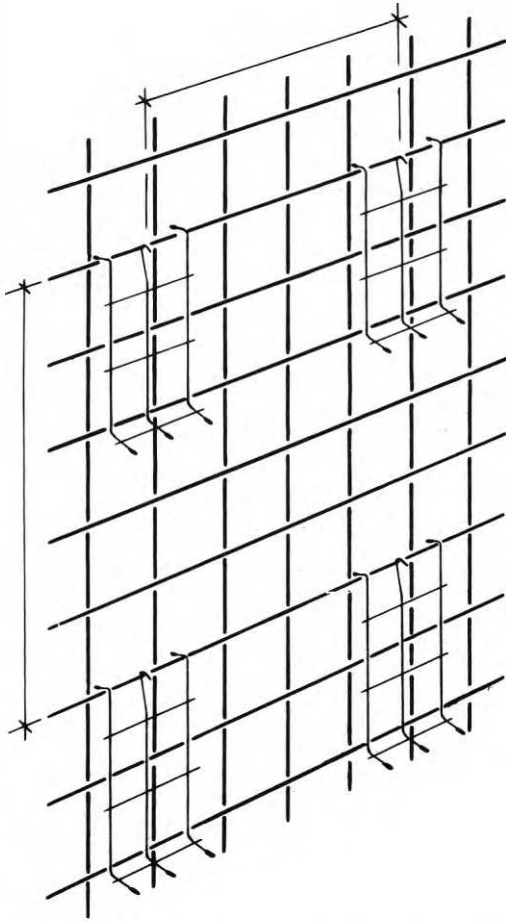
De mått mellan distansorganen, som bör underkastas bestämmelser för undvikande av alltför stora deformationer hos väggarmeringen.
